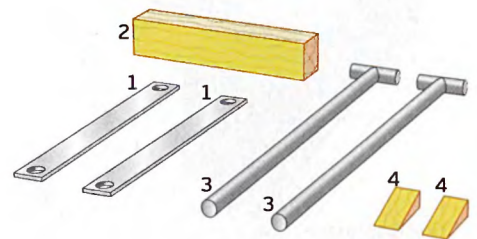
Комплект креплений щитов опалубки: 1 — пластины; 2 — распорный брусок; 3 — шкворни; 4 — клинья.
